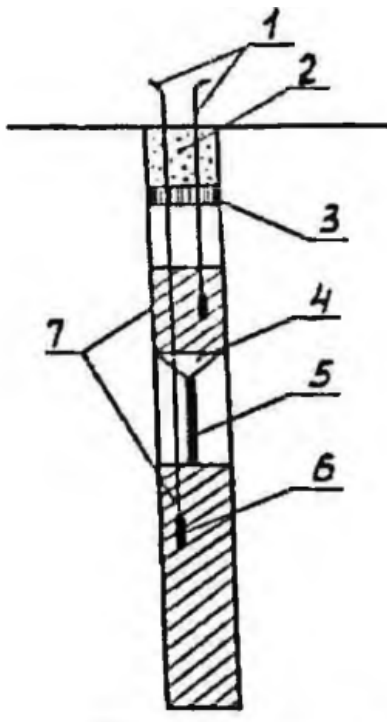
Конструкція свердловинного заряду з повітряними проміжками: 1 – детонуючий шнур; 2 – забивка; 3 – пробка; 4,5 – деталі пристрою для формування повітряного проміжку; 6 – бойовик; 7 – заряд ВР
